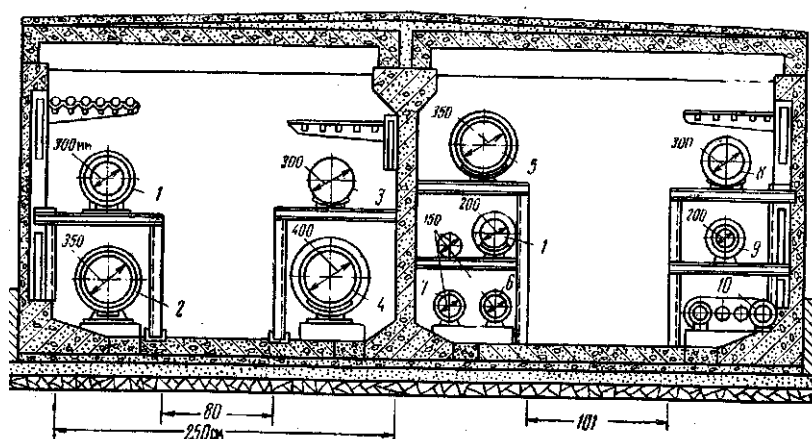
Поперечное сечение двухсекционного коллектора: 1 — паропровод; 2 — резервный паропровод; 3 — воздухопровод; 4 — подающий теплопровод; 5 — обратный теплопровод; 6 — напорный конденсатопровод; 7' — трубопровод умягченной воды; 8 — вентиляционный трубопровод; 9 — трубопровод горячей воды; 10 — мазутопроводы с обогревом
